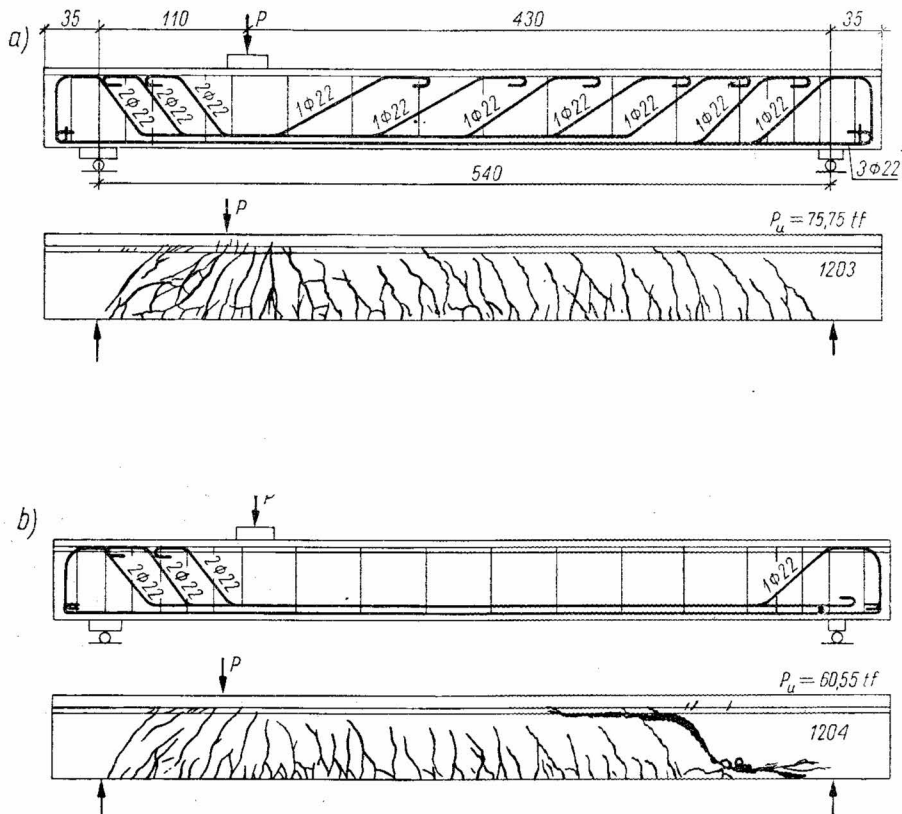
Poutres dans les essais de DAFé, cahier 67 (série II) [30] : a) poutre No 1203 avec le cisaillement entièrement transmis par l'armature, b) poutre No 1204 avec l'armature transmettant le cisaillement total sur la longueur de la poutre où  $\tau > 4,0 \text{ kgf/cm}^2$
